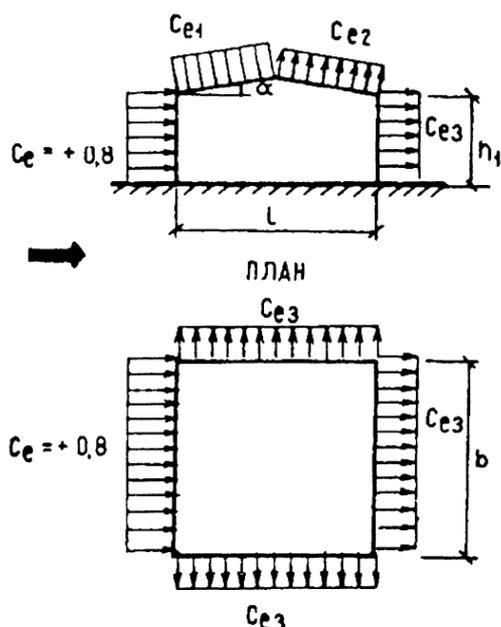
Расчетная схема ветровых нагрузок на ограждающие конструкции
